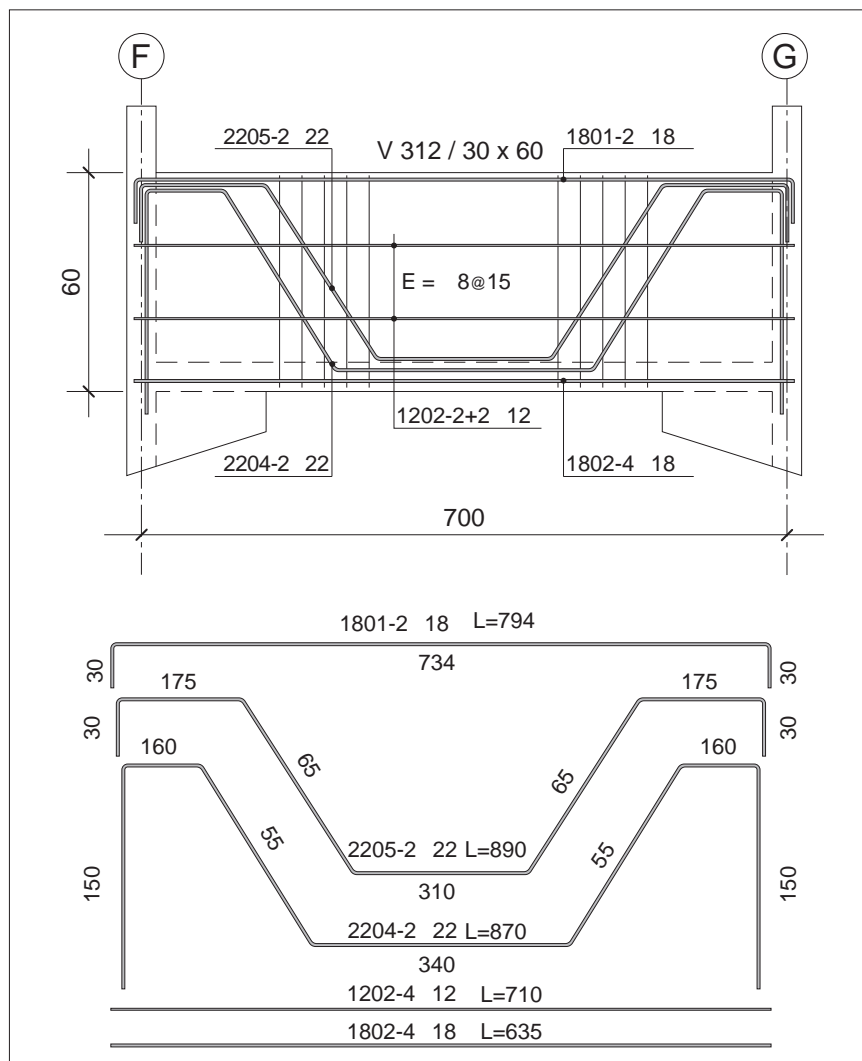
Plano de Detalle Viga 312 (fuera de escala).
